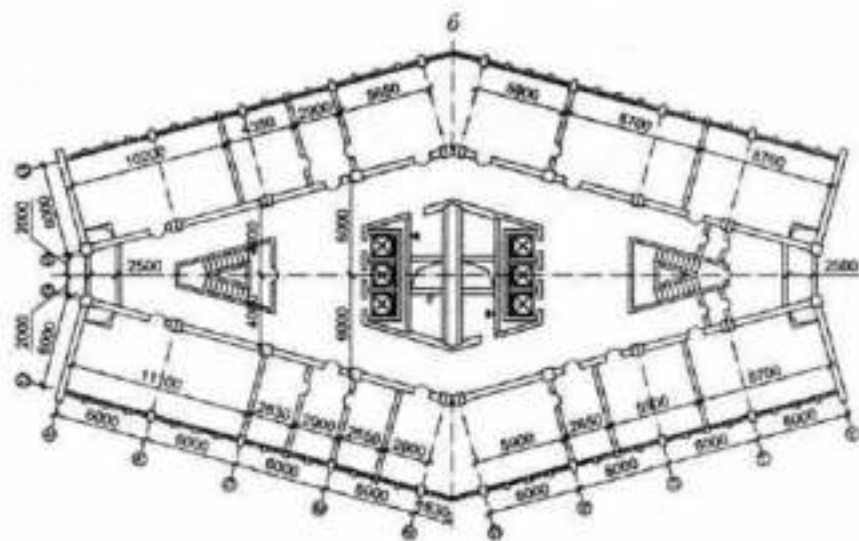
Будівля із стовбуром жорсткості та колонами каркаса у м. Києві:
